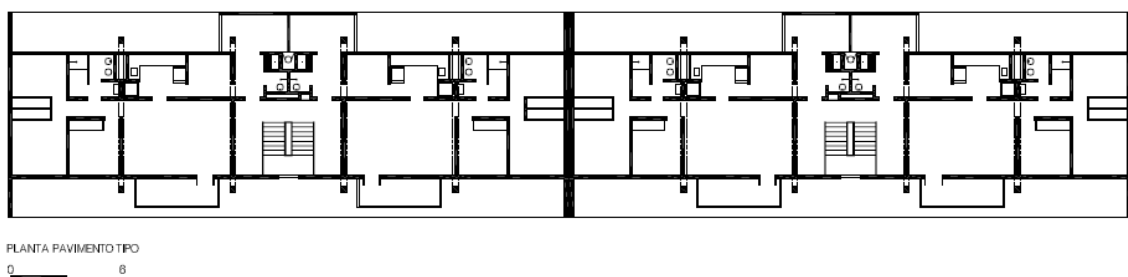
Planta do pavimento tipo do RE. Fonte: Lima (2011, p.61).
